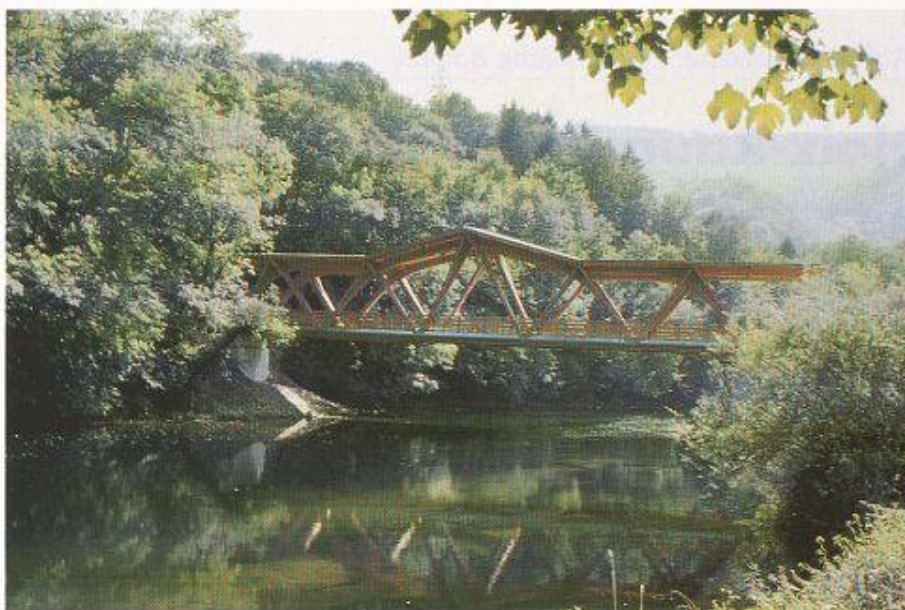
Der aufgelöste Querschnitt der Querträger macht diese für den Betrachter fast unsichtbar und lässt den Untergurt schlank erscheinen. Die geringe Dachneigung trägt ebenso zum leichten Aussehen bei
